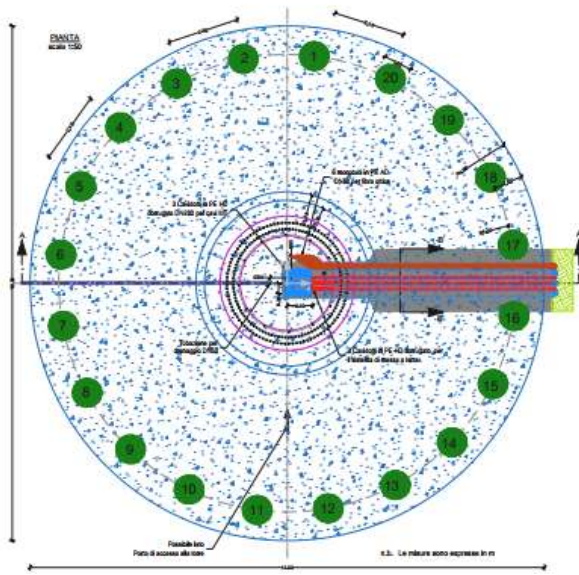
Pianta del plinto con indicazione dei pali di fondazione (n.20 del diametro 100 cm)
